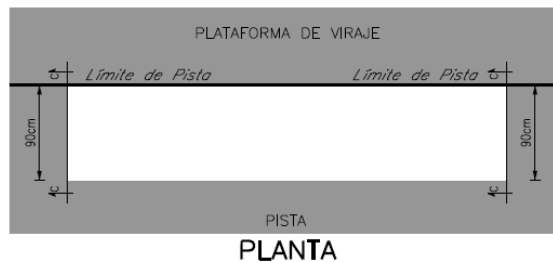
Detalles en planta y corte sobre colocación en pavimento de Señal de Faja Lateral de Pista.
